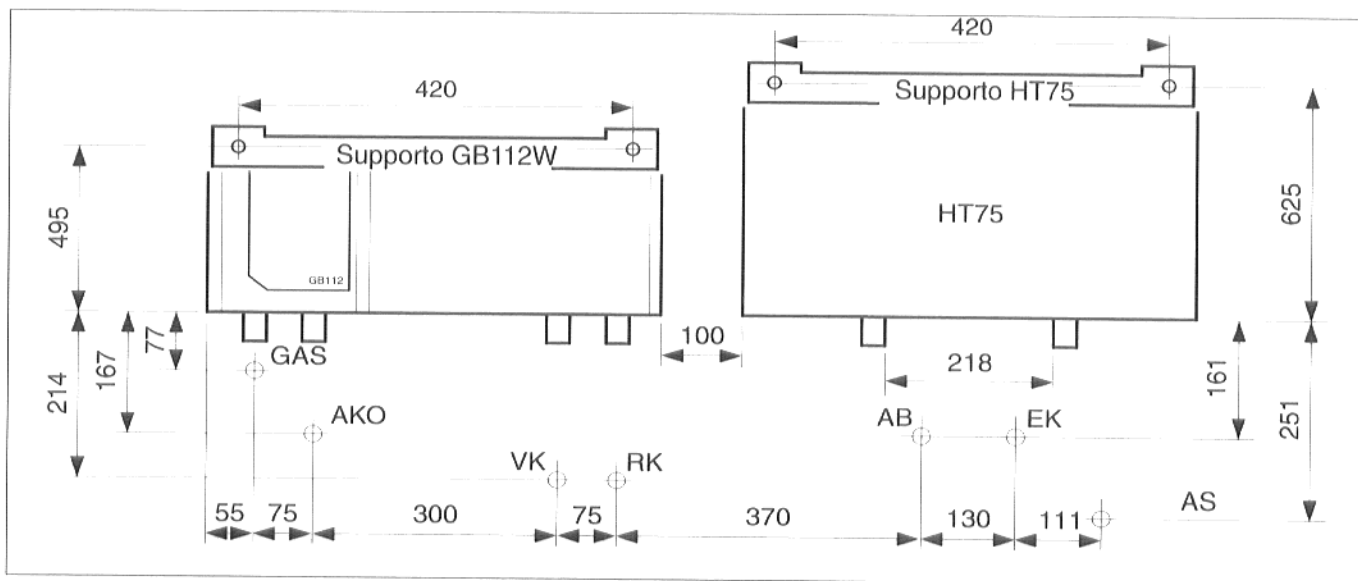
dimensioni di ingombro GB112-24/W oppure -29/W con HT75 a destra
